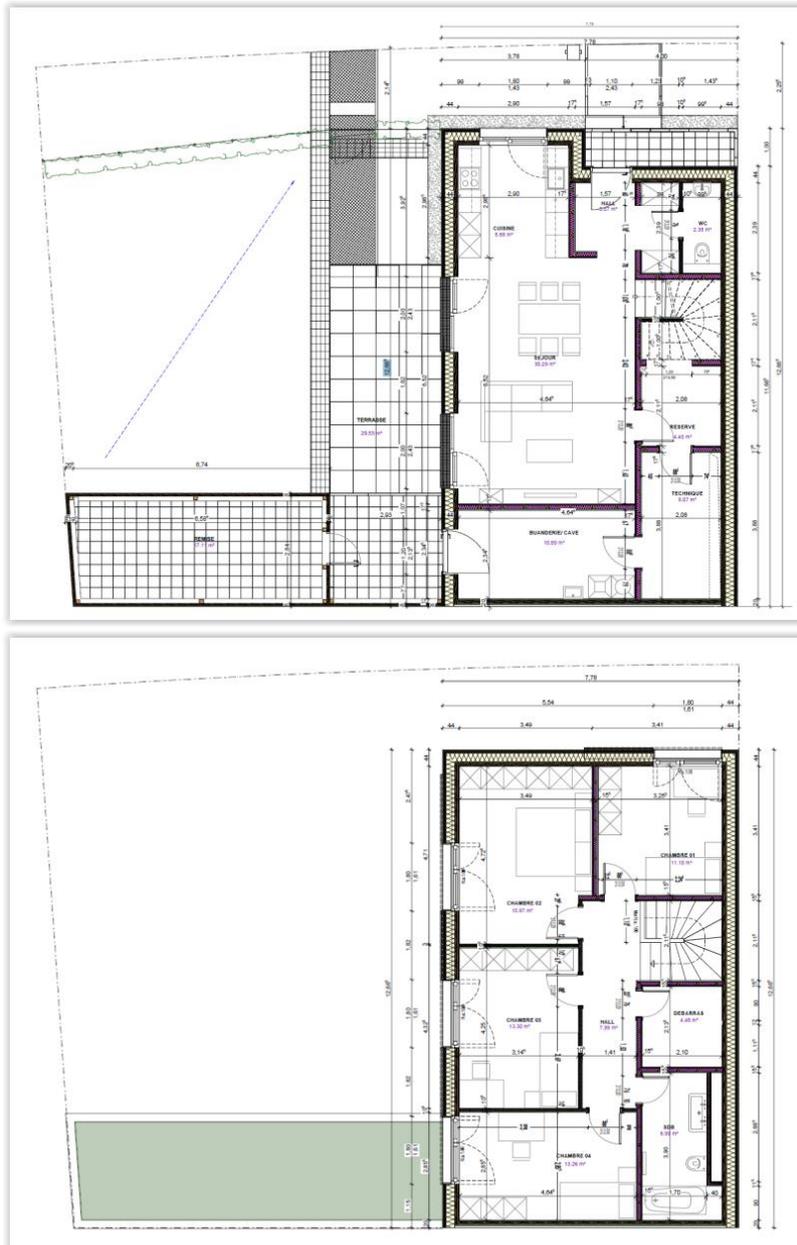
Grundrisse ein eines Musterhauses (Typ 7) – Erdgeschoß und Obergeschoß
